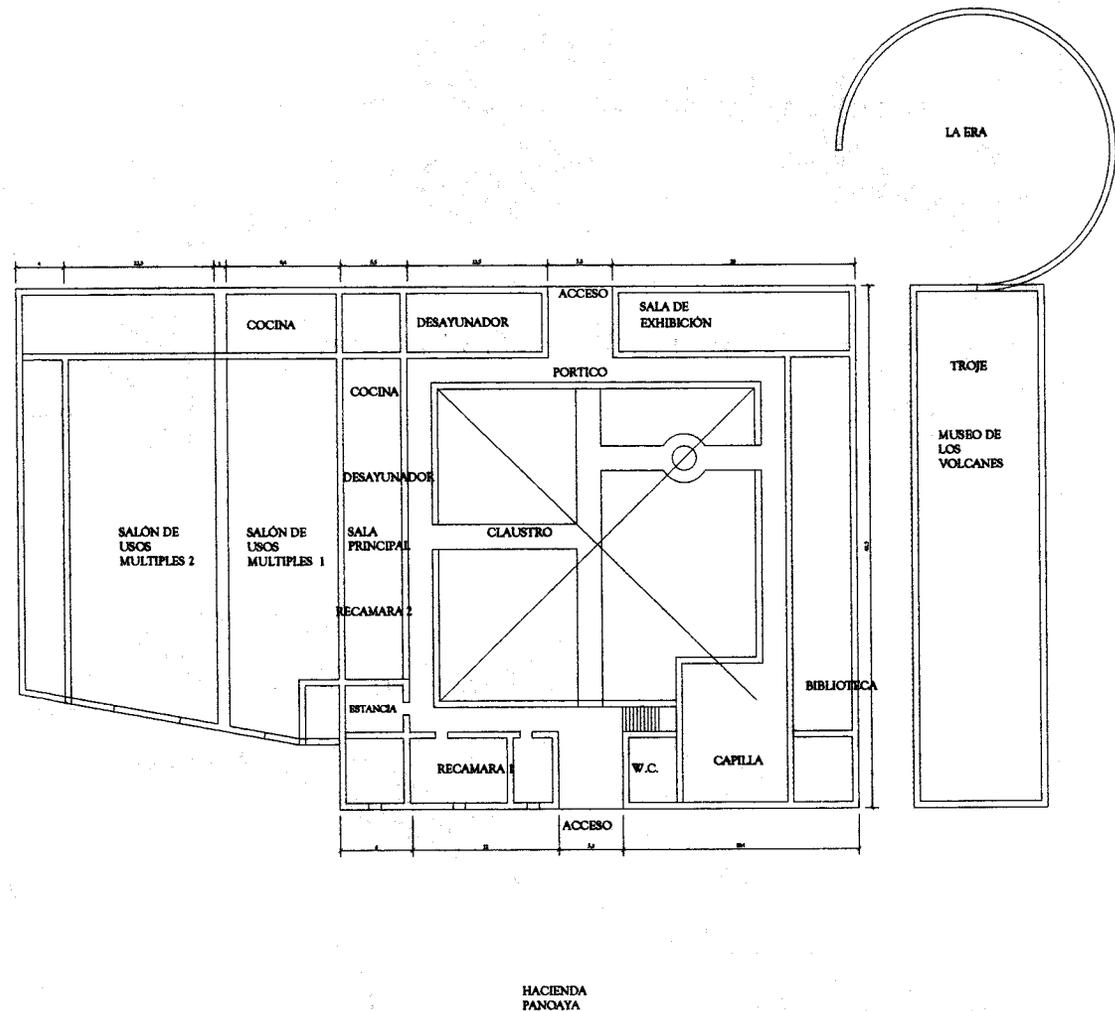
PLANTA ARQUITECTÓNICA DONDE SE VEN LAS AREAS QUE COMPONEN EL CASCO DE LA HACIENDA DE PANOAYA QUE AHORA SU USO HA SIDO MODIFICADO.
